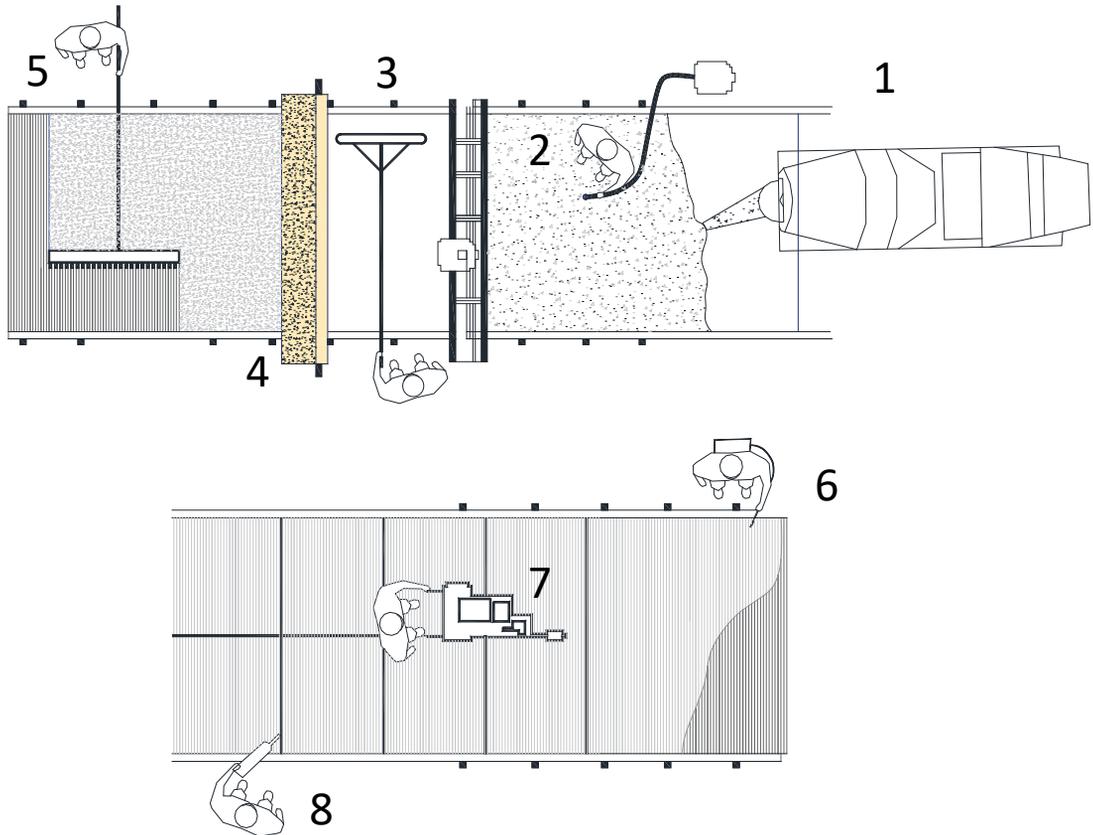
Esquema de la construcción de un pavimento de concreto hidráulico con cimbra fija.
